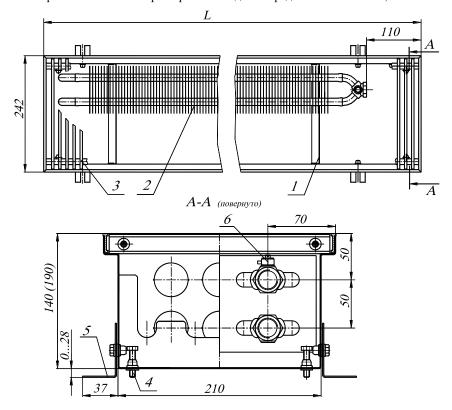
Конвектор КРК 24.14(19).60...300 концевой 1 - короб установочный; 2 — элемент нагревательный; 3 — решетка; 4 — болты упорные; 5 — кронштейны,; 6 -. клапан воздухоспускной;
